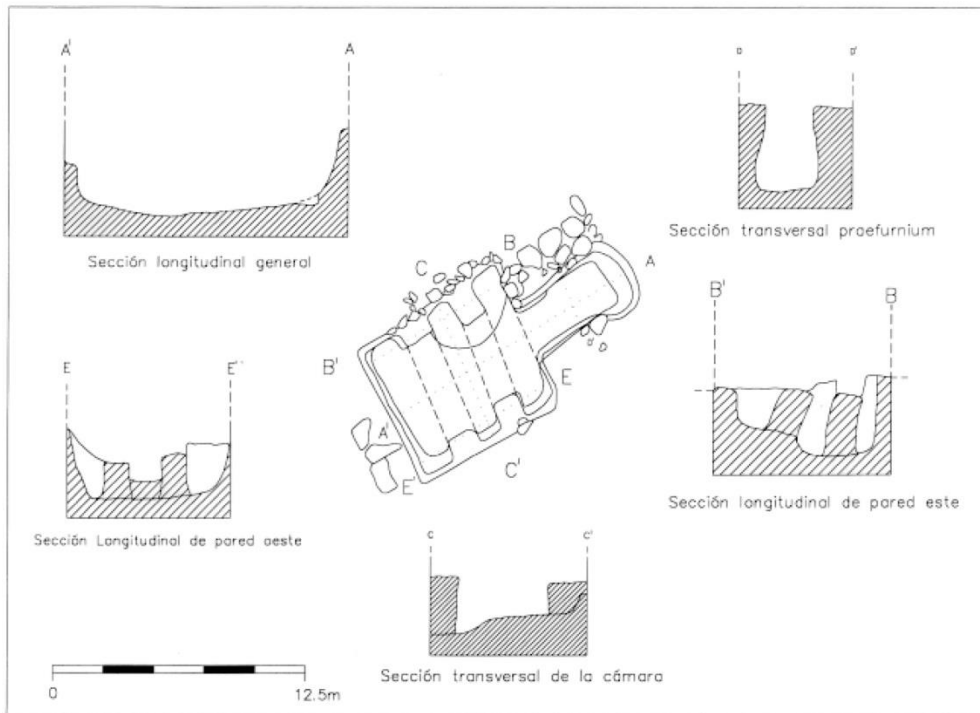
Planta y secciones del horno documentado en calles Ollerías, Dos Hermanas y Parras (Salado & Rambla, 2002).
